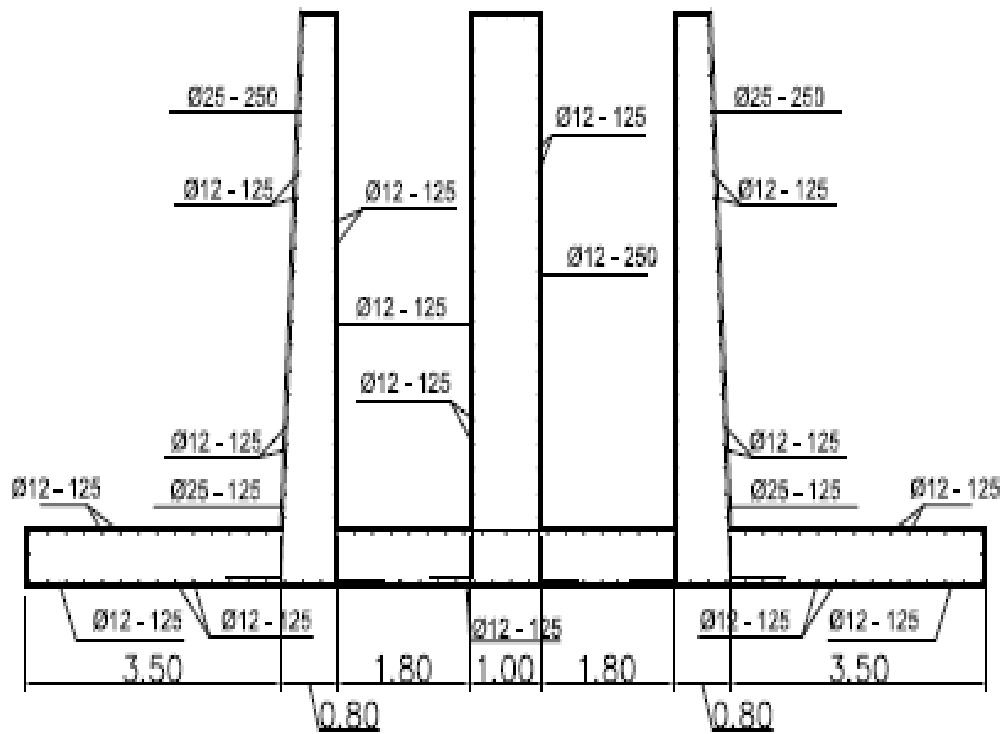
Tampak depan *In Take* kanan (1) (DED Bendung Sei Wampu)
